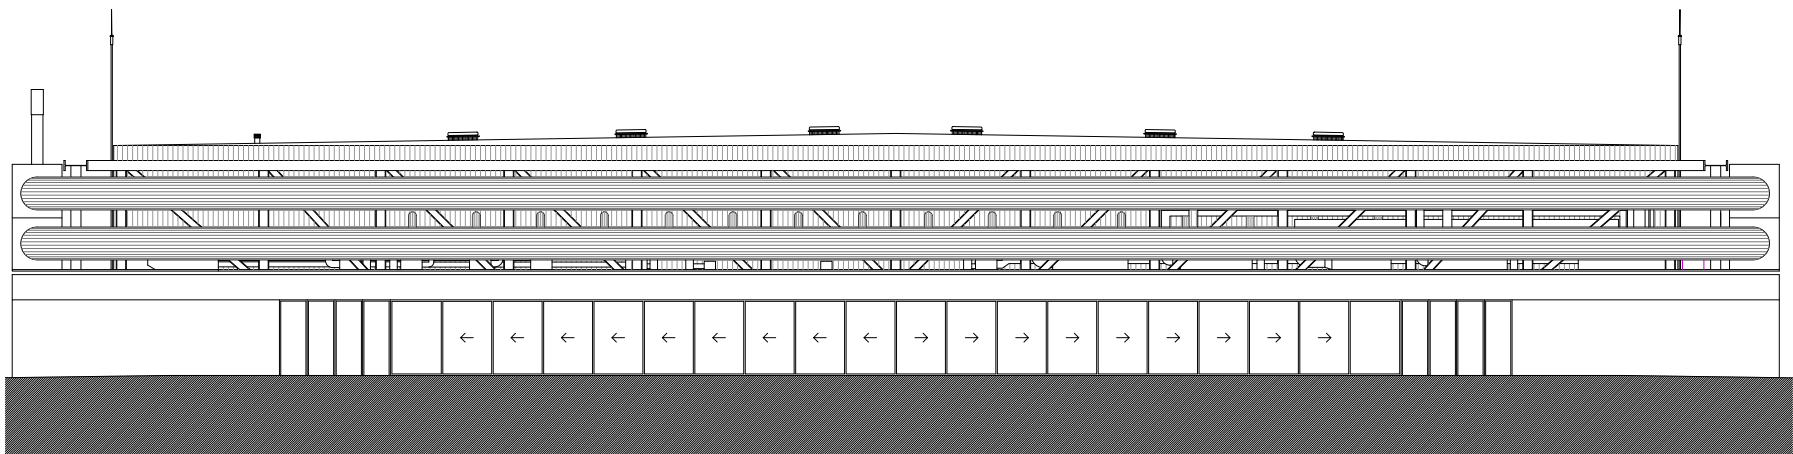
Alzado sur do Centro Cultural. Escala 1/300.
